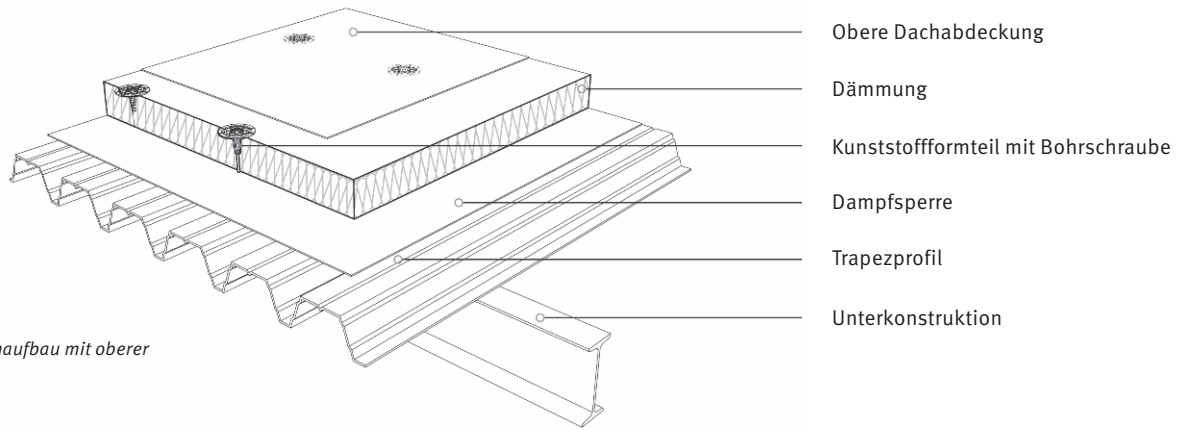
Einschaliger Dachaufbau mit oberer Abdichtung
